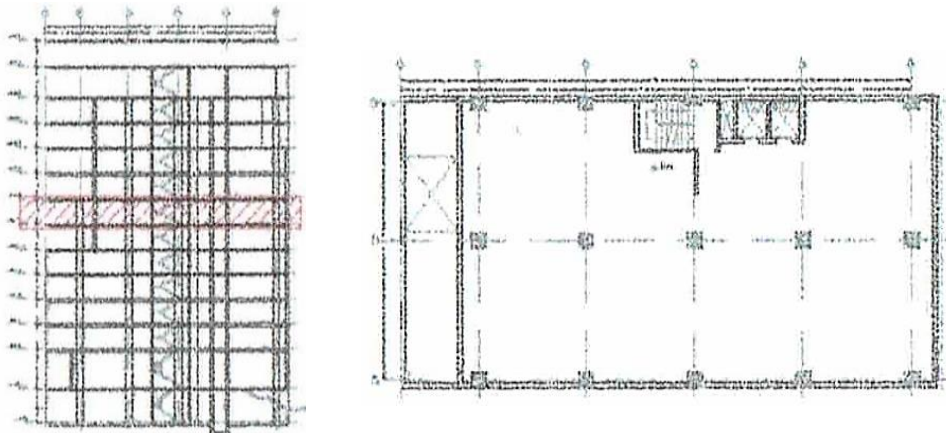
Elevación y planta esquemática del edificio Scientology del Valle (Gómez González, 2020).
